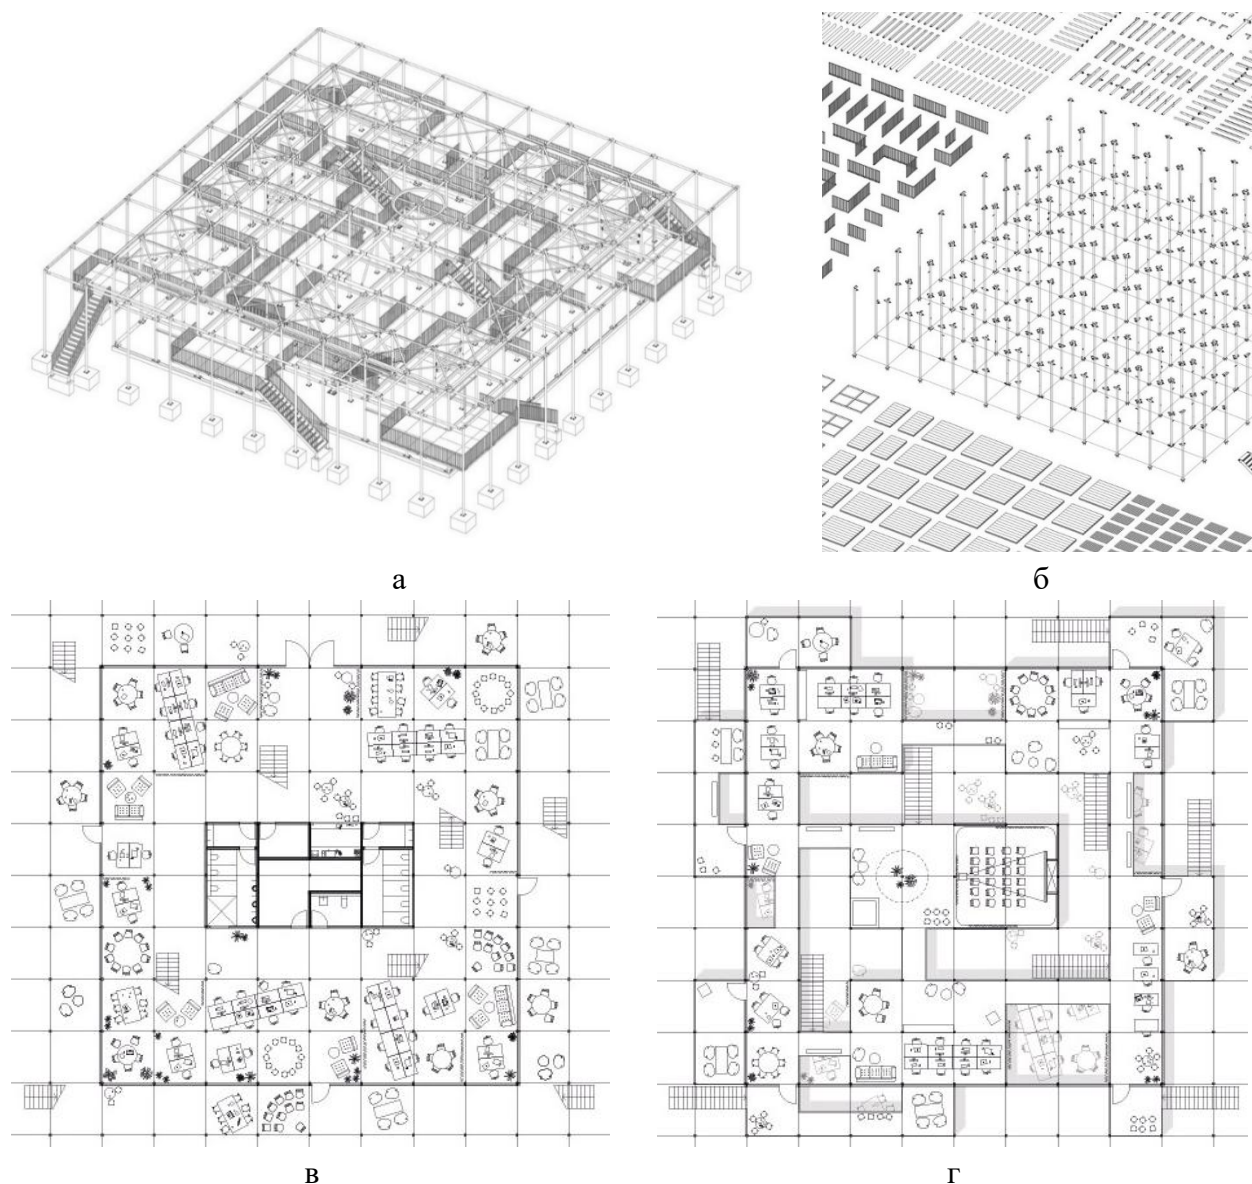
Навчальний павільйон кампусу Технічного університету Брауншвейга, Німеччина [37]: а – ізометрія споруди; б – модульні елементи; в – план першого поверху; г – план другого поверху;
